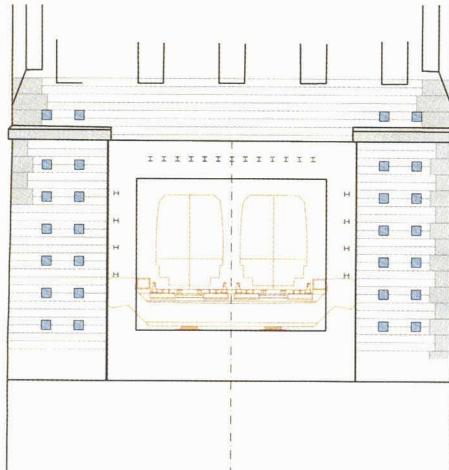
Modélisation de la pile Caroline du pont Bessières
